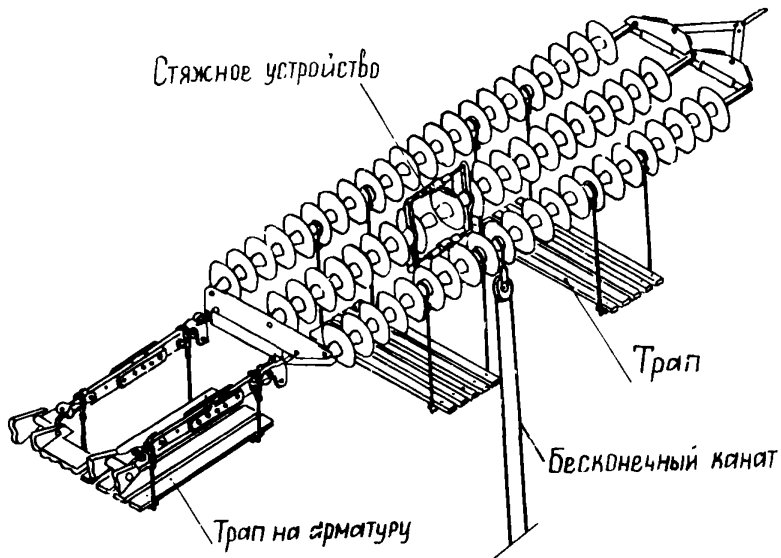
Расстановка приспособлений в натяжной гирлянде
